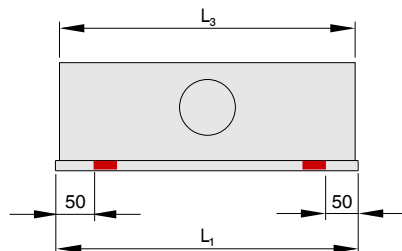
Frontschiene Länge = Anschlusskastenlänge
